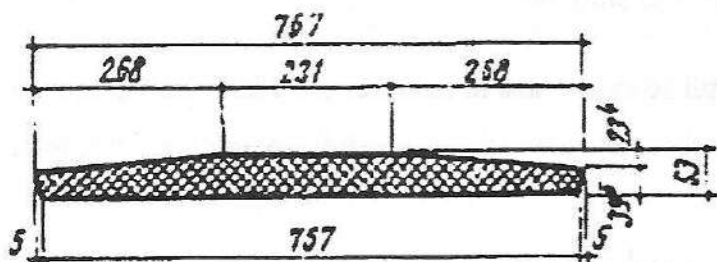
Element prefabricat din beton armat tip bolțar pentru pretensionarea pereților celei de siloz.
